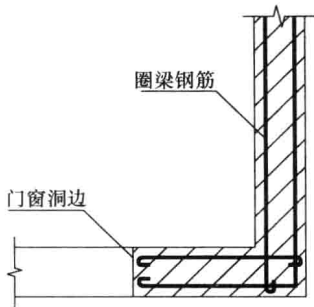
配筋砖圈梁在洞口边、转角处钢筋搭接做法
